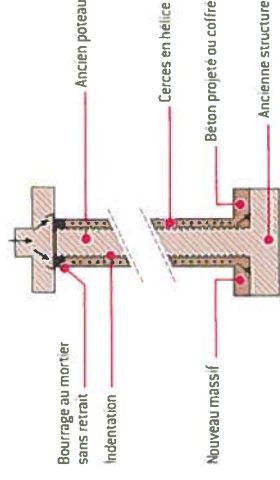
Chemisage en béton armé d'un poteau + fondation renforcée (coupe transversale)
